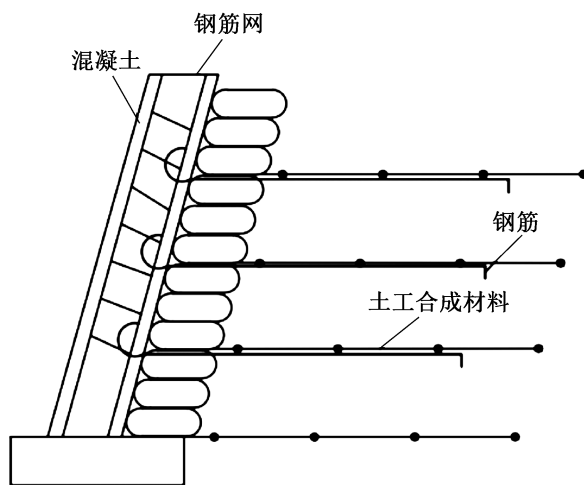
整体现浇混凝土墙面结构形式示意图
